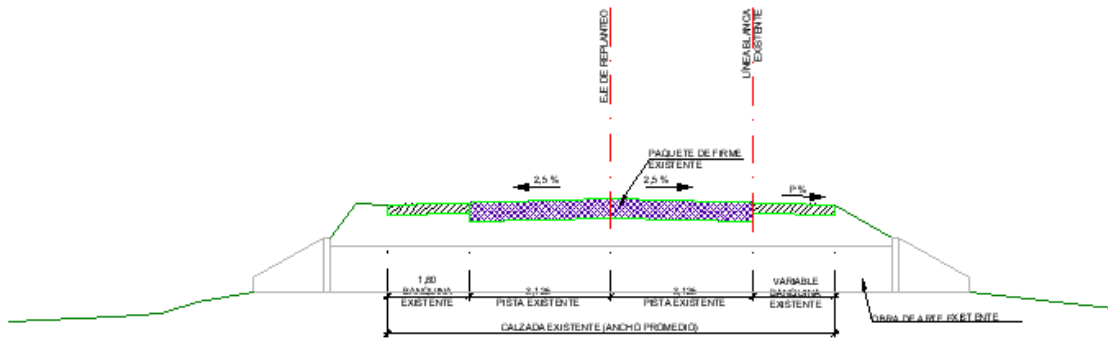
Detalle de la sección tipo de cazada actual con una obra de arte existente.
